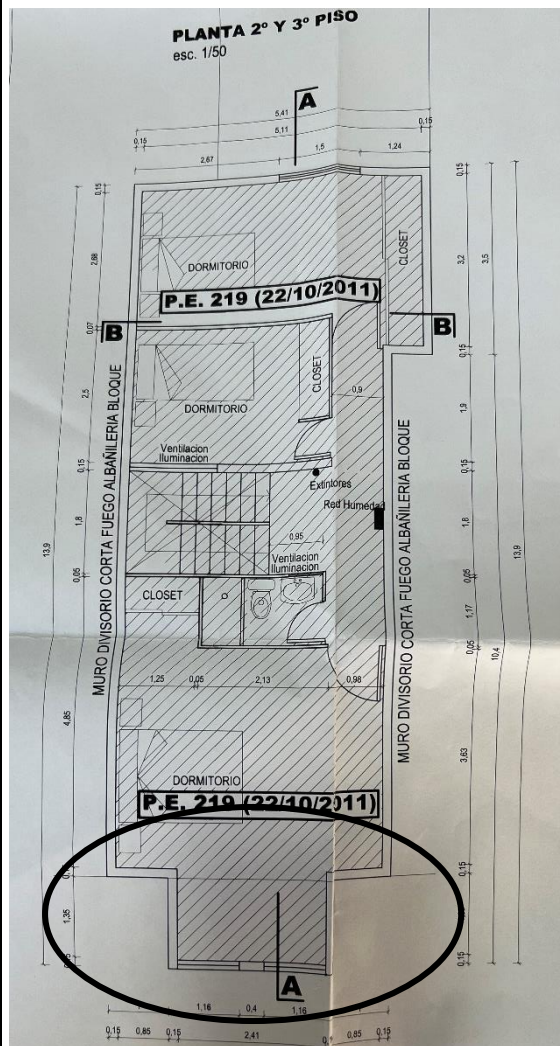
Lámina N° 1, planta 2° y 3° piso
